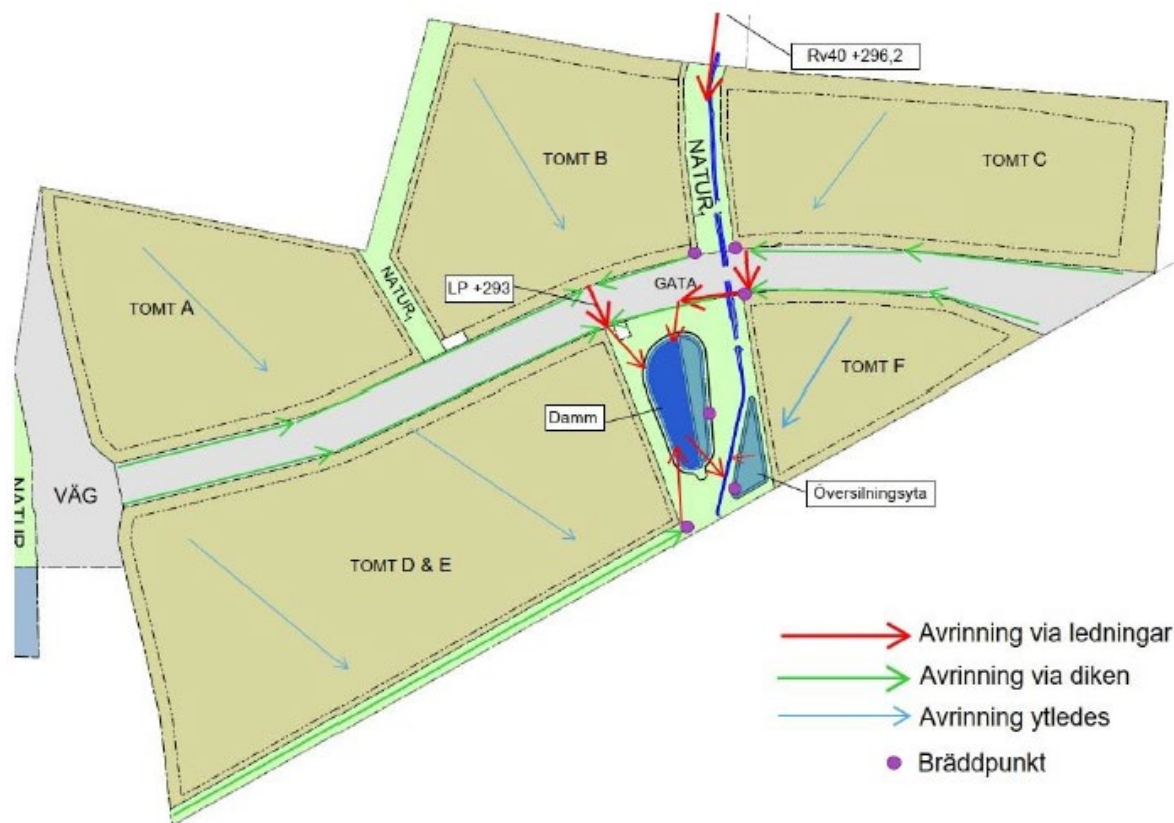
Avrinningsvägar inom planområdet visas med pilar.
